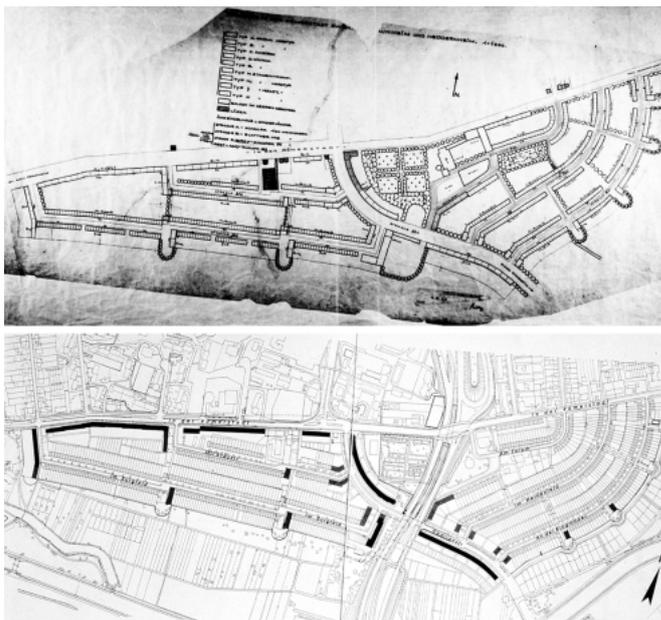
Plano de la Römerstadt (E. May, 1927-28). Plano parcelario, estado actual. En negro edificios de viviendas colectivas.
